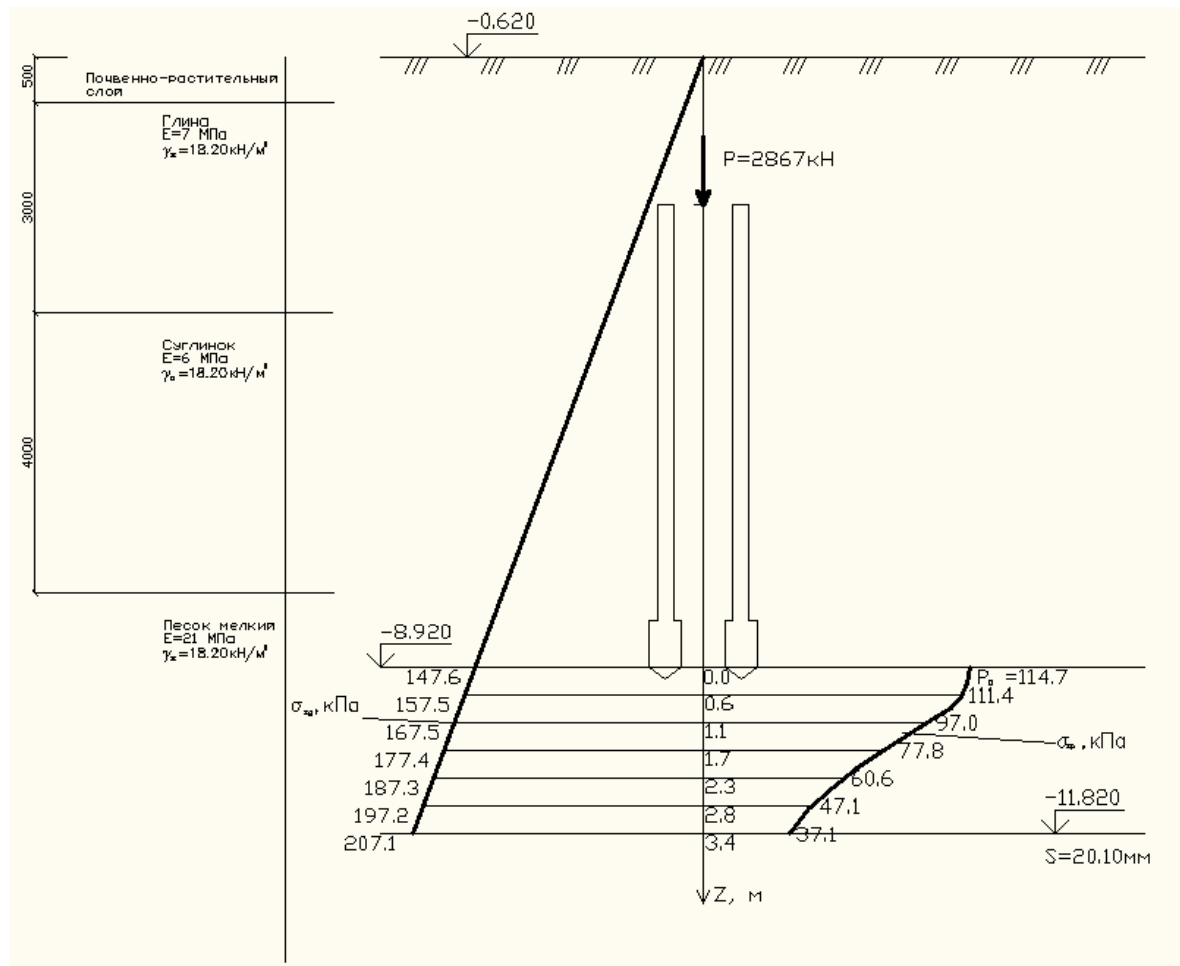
Осадка фундамента, состоящего из свай с наконечником
